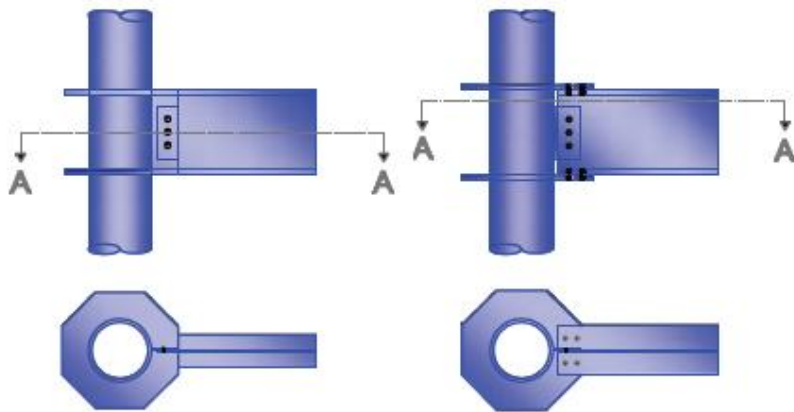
Ligação viga-coluna com diafragmas transversais externo.
